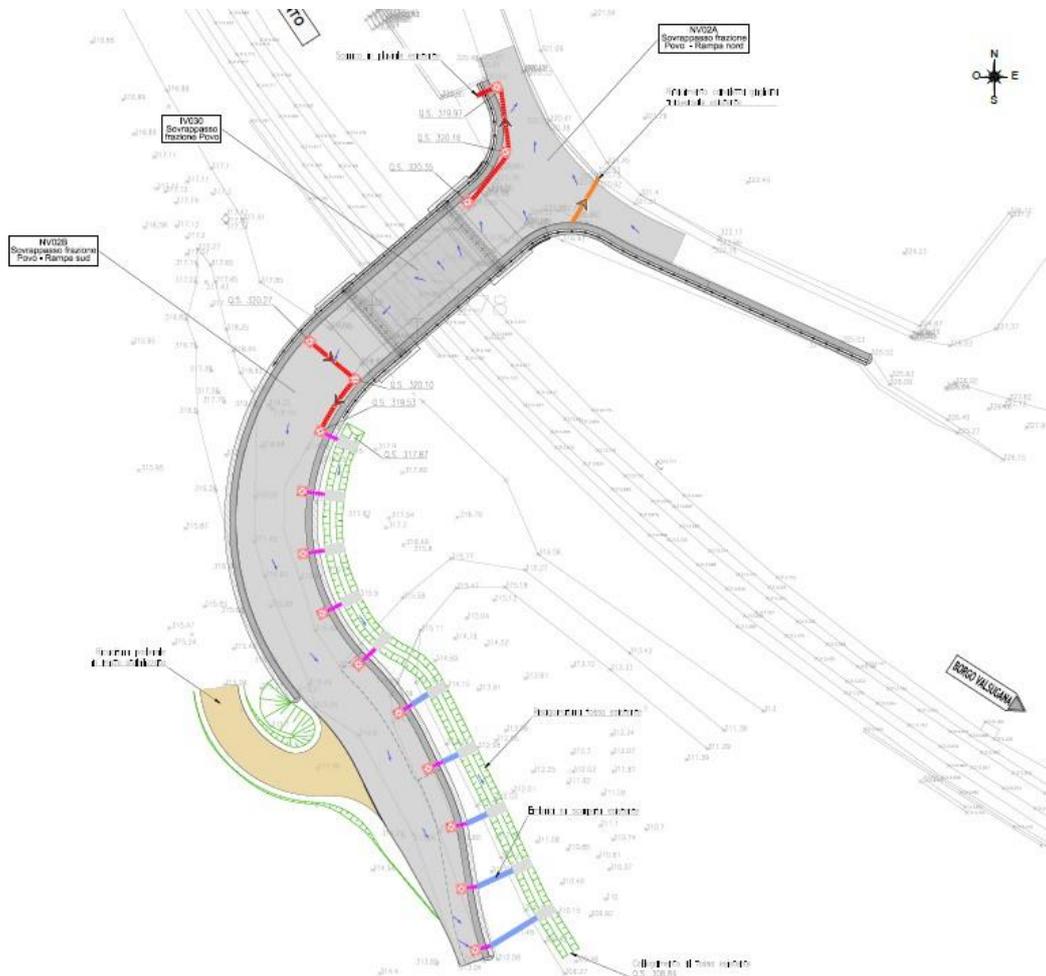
Planimetria rete smaltimento acque meteoriche
